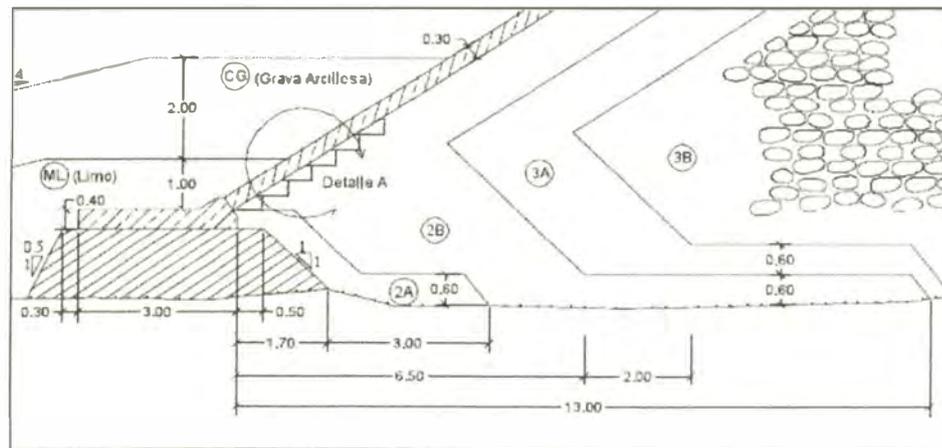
Zona de contacto entre la losa y el relleno de presa de enrocado (Odebrecht Ingeniería y Construcción "Expediente Técnico proyecto Traslase Olmos", 2004)
